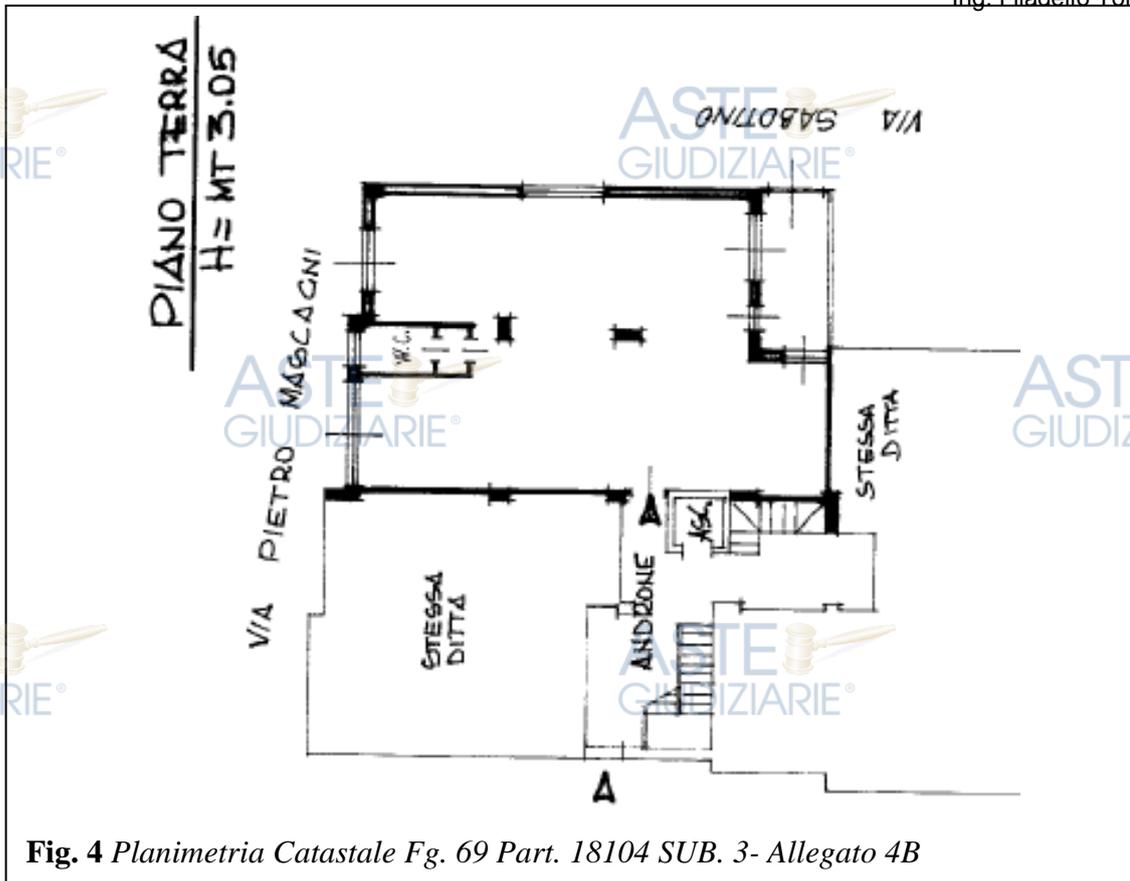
Planimetria Catastale Fg. 69 Part. 18104 SUB. 3- Allegato 4B
